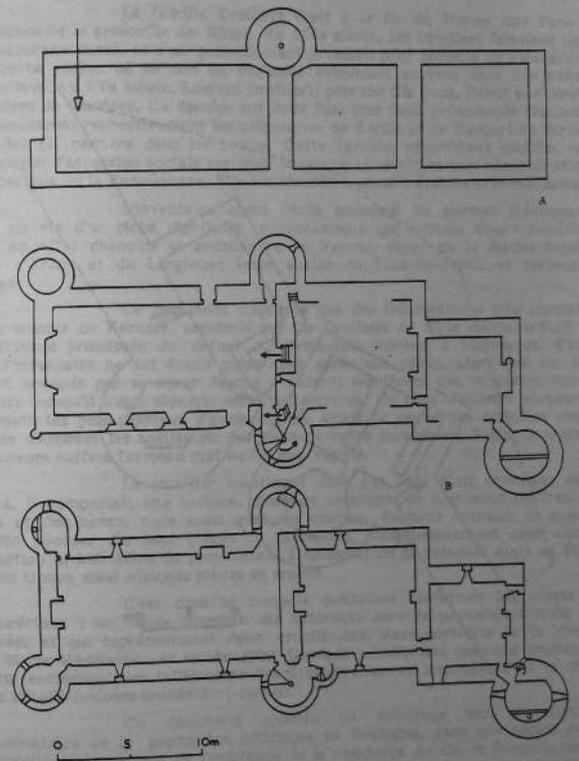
A : Nantes. Manoir de la Touche ; plan au rez-de-chaussée (la flèche indique la porte d'entrée) B : Le Quiou. Manoir du Hac: plans du rez-de-chaussée et du second étage.
